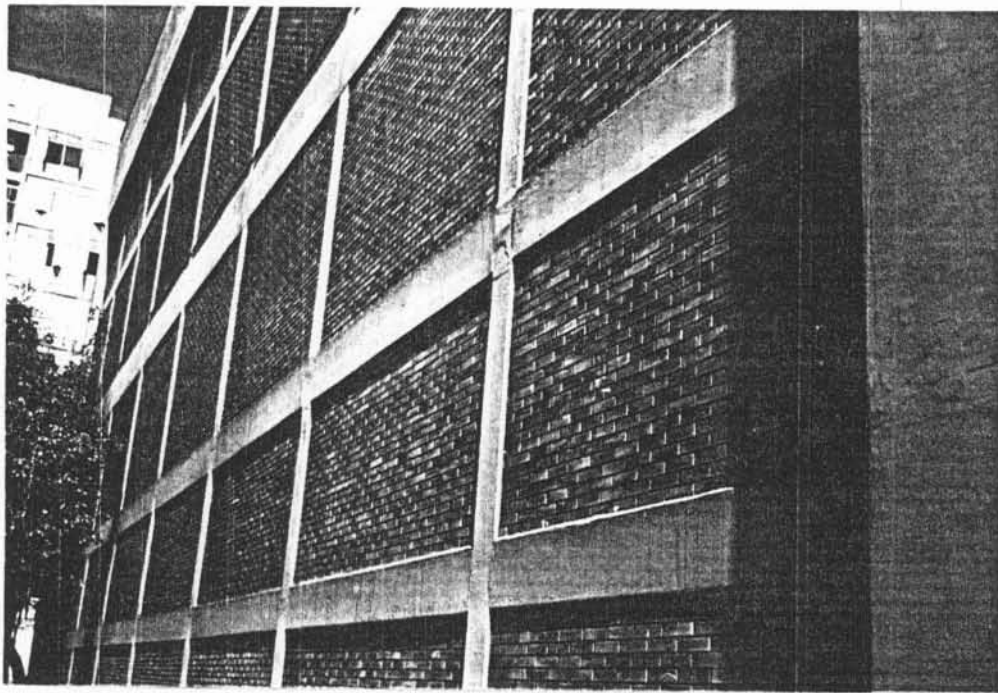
Estrutura de concreto hiperestática, cujo vão possui 37 m contínuos, sem junta de dilatação.
